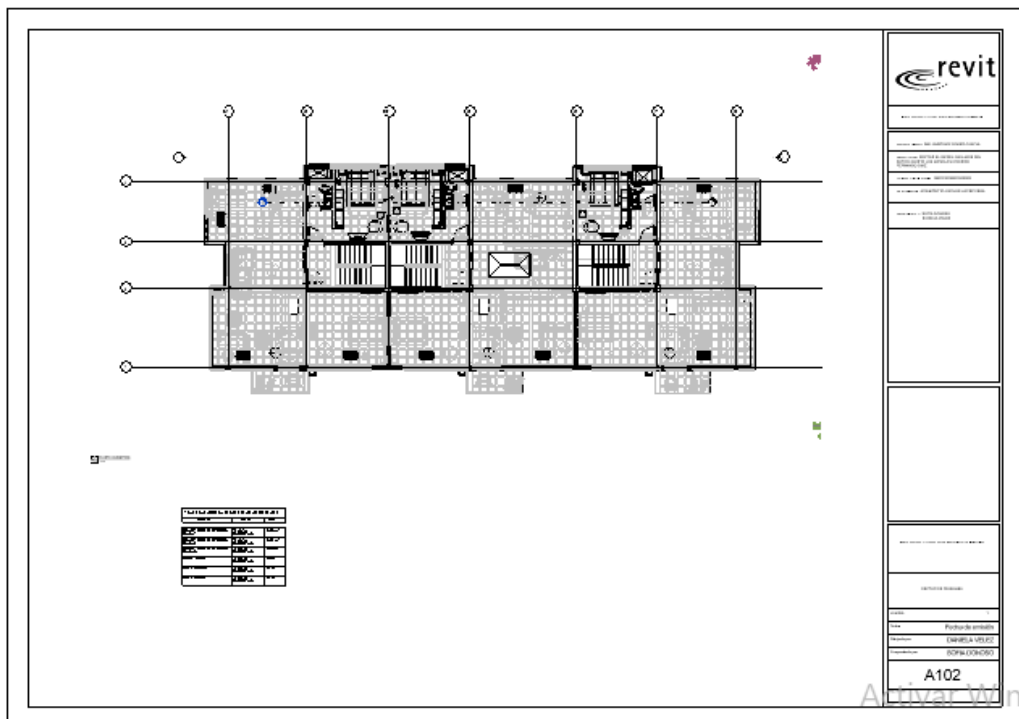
Plano de arquitectónicos, Planta Cubiertas
